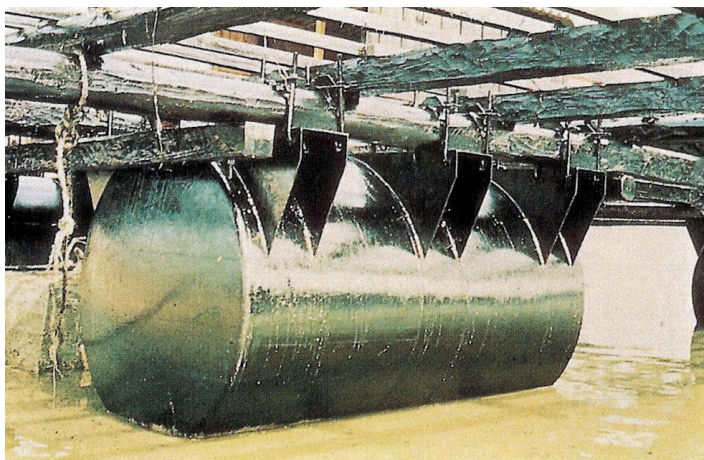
Unión de las vigas maestras a los flotadores (Figueiro y Cuña).
